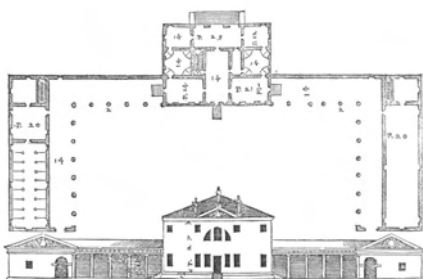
Villa Zeno - Fonte: Palladio, 1570.
